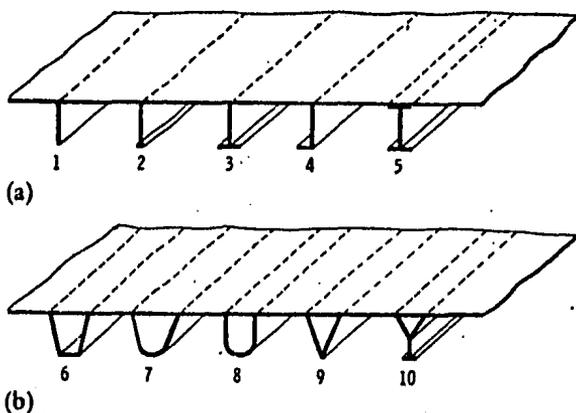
TIPOS DE NERVADURAS UTILIZADAS PARA LOS TABLEROS.
